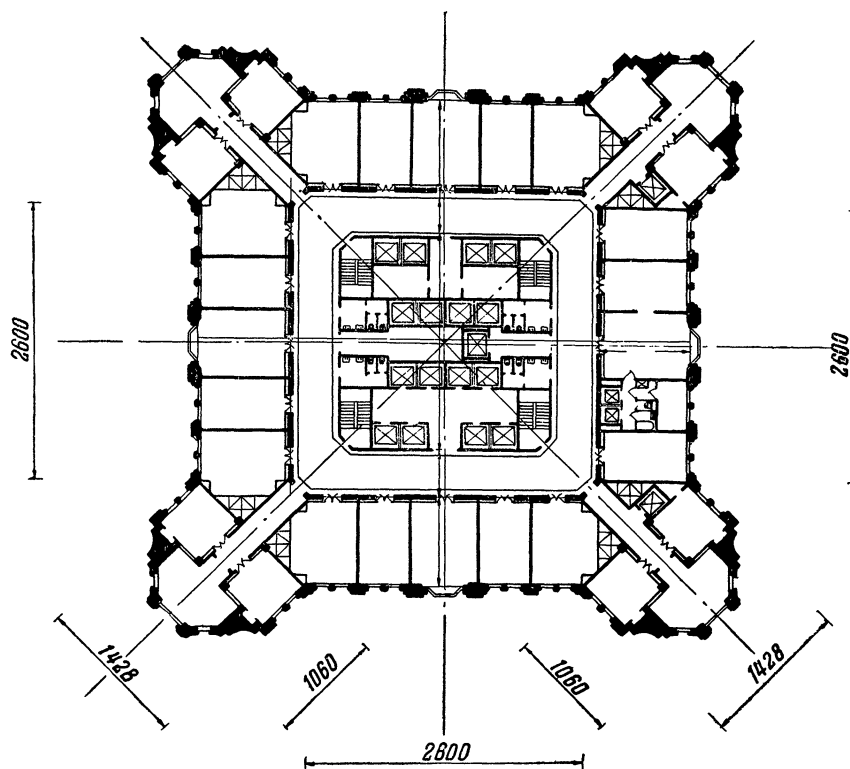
32-этажное здание в Зарядье. План верхнего объема (с 15 до 32-го этажа). Один из вариантов проекта
